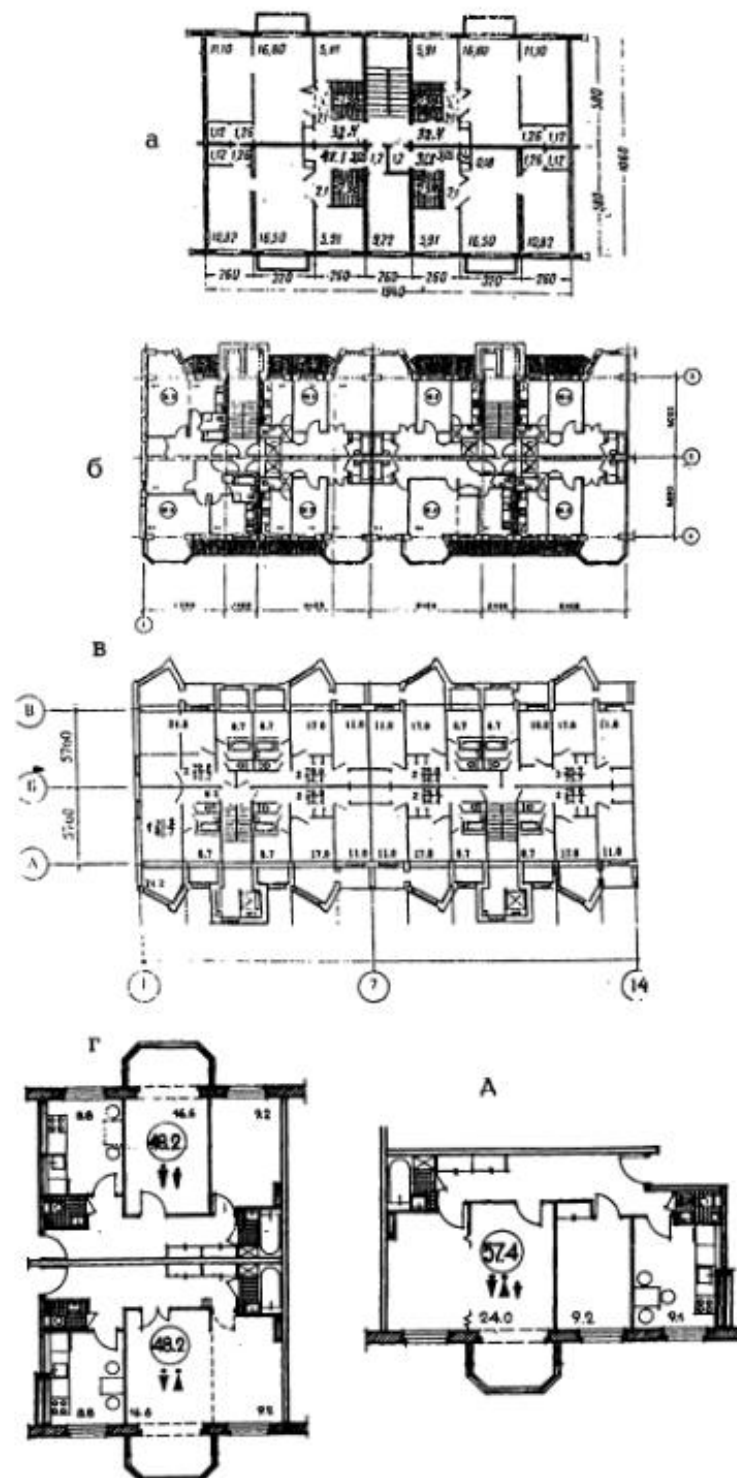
Модернизация планировки квартир и секций в типовых 5-этажных домах: а – исходная планировка (типовая серия 1-465); б – модернизация рядовой и торцевой секций панельного дома с продольными несущими стенами, в – с перекрестными стенами малого шага, г – модернизация планов двухкомнатных квартир с сохранением и уменьшением числа комнат, д – то же, трехкомнатной
